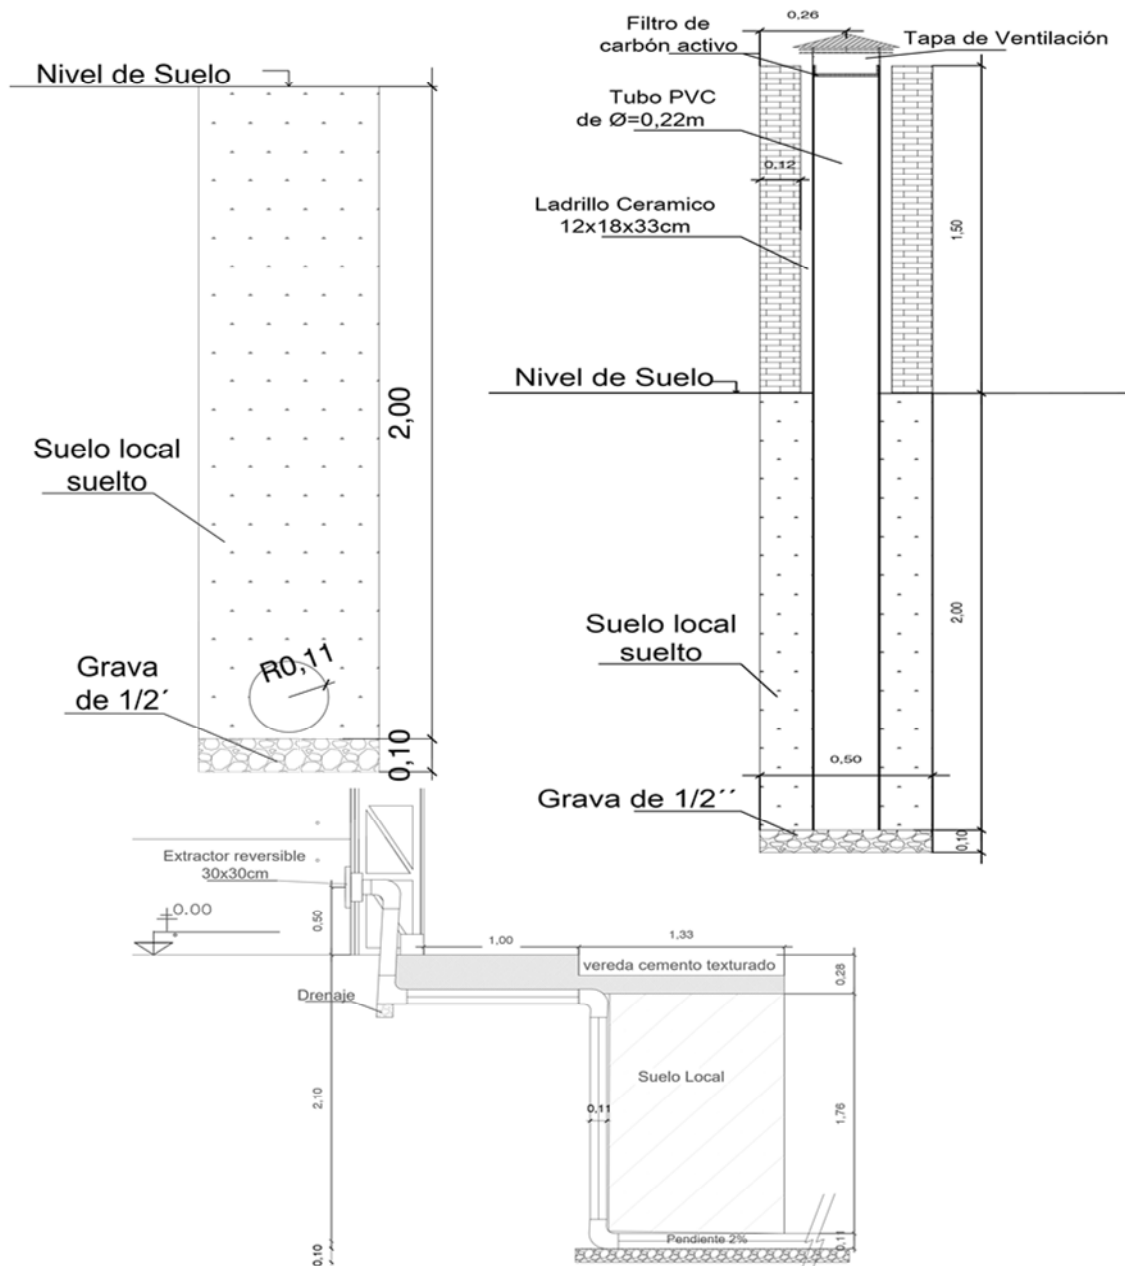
Detalles de la instalación de geotermia de baja entalpía..
